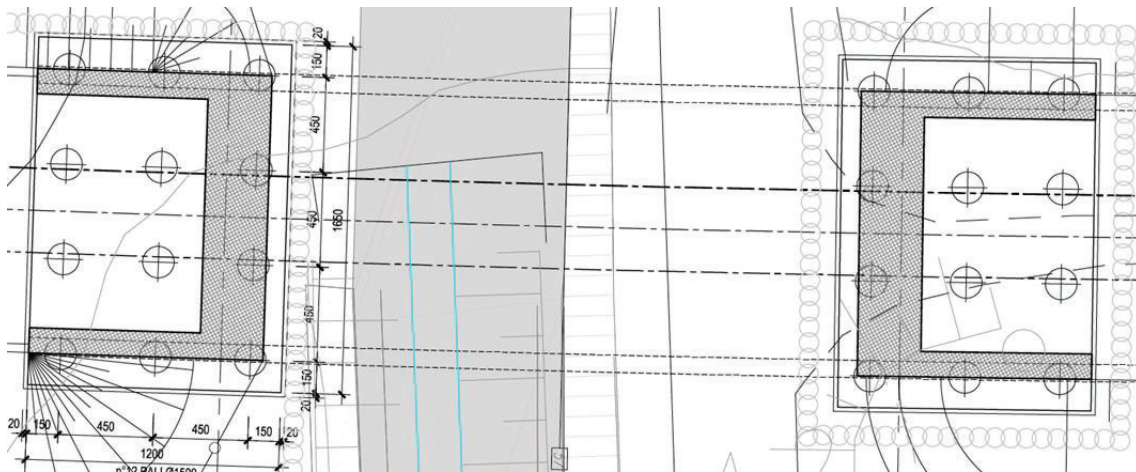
Pianta delle fondazioni delle pile e delle spalle
